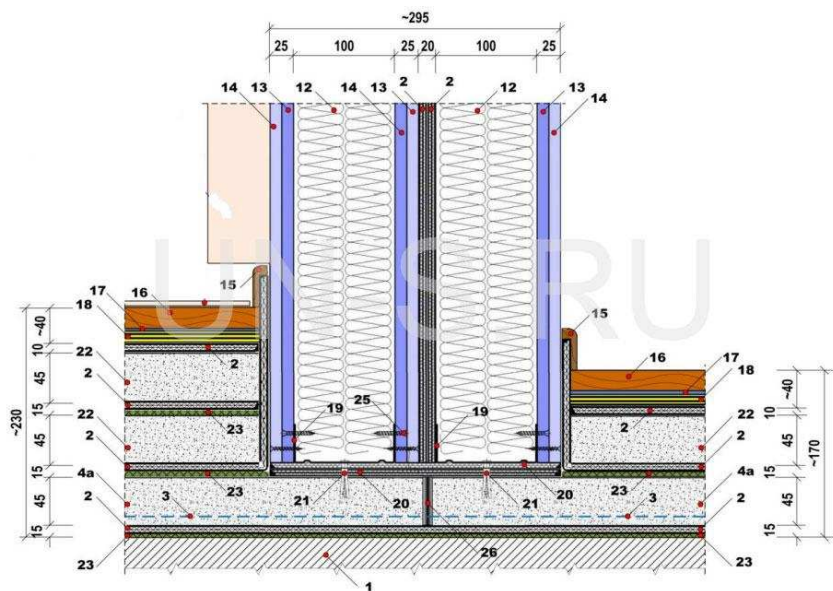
Схема звукоізоляції приміщень: 1 – плита перекриття; 2 – звукоізоляція, 10...14 мм; 3 – сітка арматурна; 4а, 4б – стяжка цементно-піщана; 5 – гідроізоляція; 6 – вирівнююча стяжка під плитку; 7 – плитковий клей; 8 – плитка; 9 – цементно-піщана штукатурка; 10 – шов кладки; 11 – цегляна кладка; 12 – акустичний матеріал в плитах, 50...100 мм; 13, 14 – ГКЛ; 15 – плінтус; 16 – паркет; 17 – клей паркетний; 18 – шліфувана фанера; 19 – каркас металевий для стін; 20 – стрічка звукоізолююча; 21 – анкерне кріплення до підлоги; 22 – напівсуха стяжка фіброармована цементно-піщана; 23 – картон базальтовий; 24 – «ліжко» цементно-піщане під цегляну кладку, армоване; 25 – саморізи для кріплення гіпсокартону; 26 – акустичний шов, 5...7 мм; 27 – існуюча стіна
